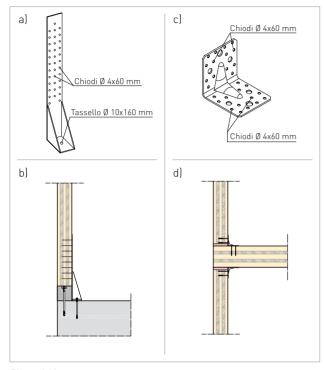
a) hold-down; b) collegamento a terra con elemento in legno interposto; c) angolare per il collegamento del pannello al solaio sottostante; d) sigillatura con bande resilienti.
